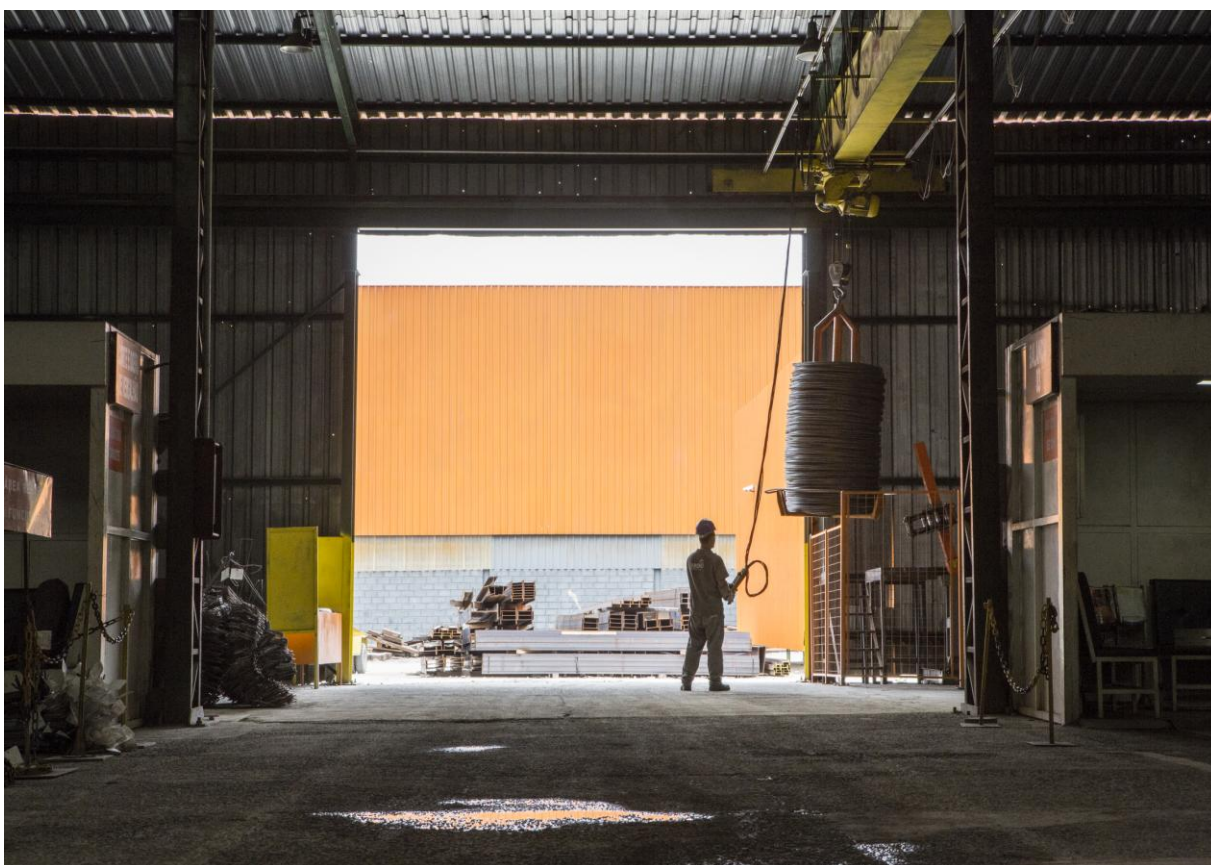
Para corte e dobra, o aço chega em bobinas de aproximadamente 2 toneladas.
